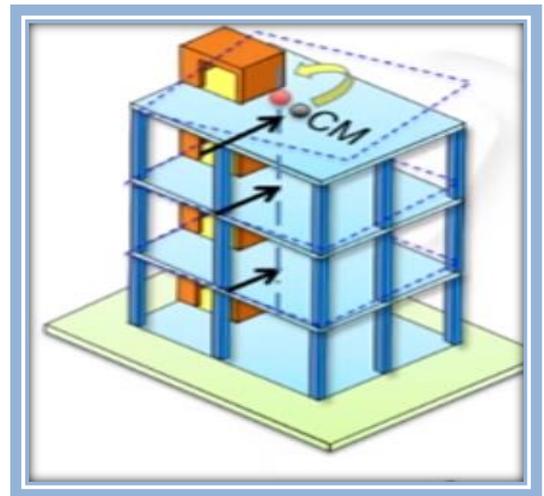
Torsión de planta Fuente: CENAPRED, 2016
